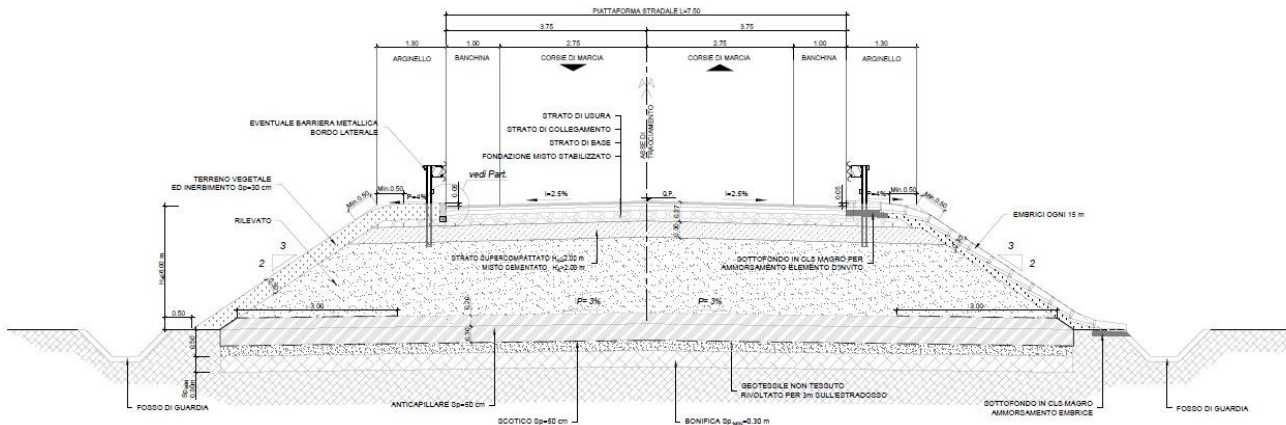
Dest. Particolare 7.5m – sezione tipo in rilevato Hril ≤ 6.00 m
